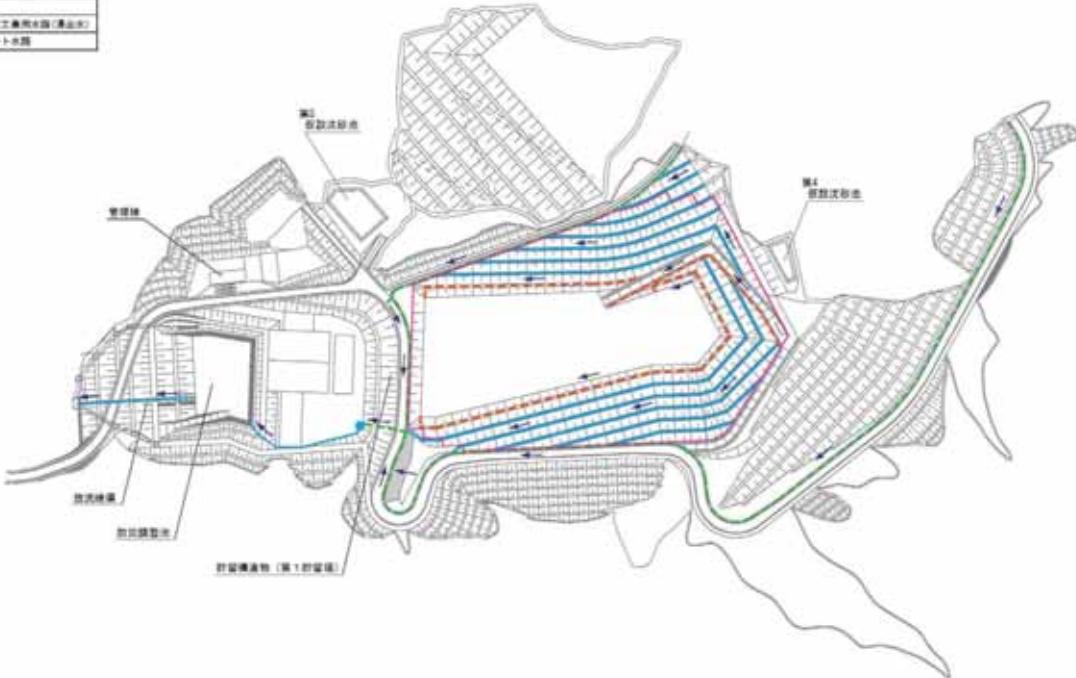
雨水集排水施設配置図 埋立開始時（第 1 期整備）
